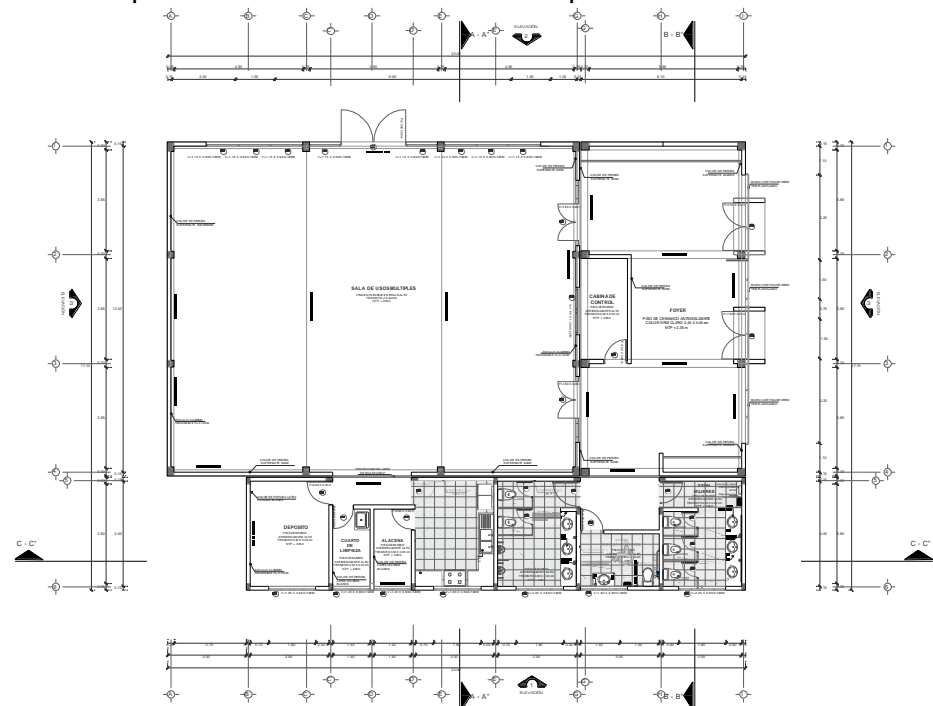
Planta de proyecto - Zona de Serv. Complementarios (SUM) - Bloque 04. Elaboración propia.
